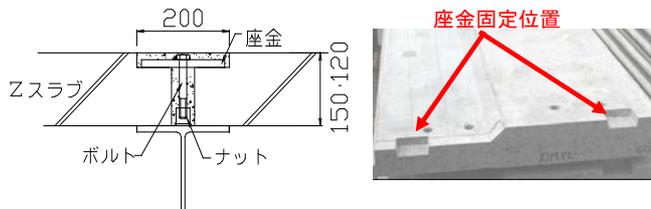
Zスラブの横桁固定概要図 写真-6 Zスラブ断面部
